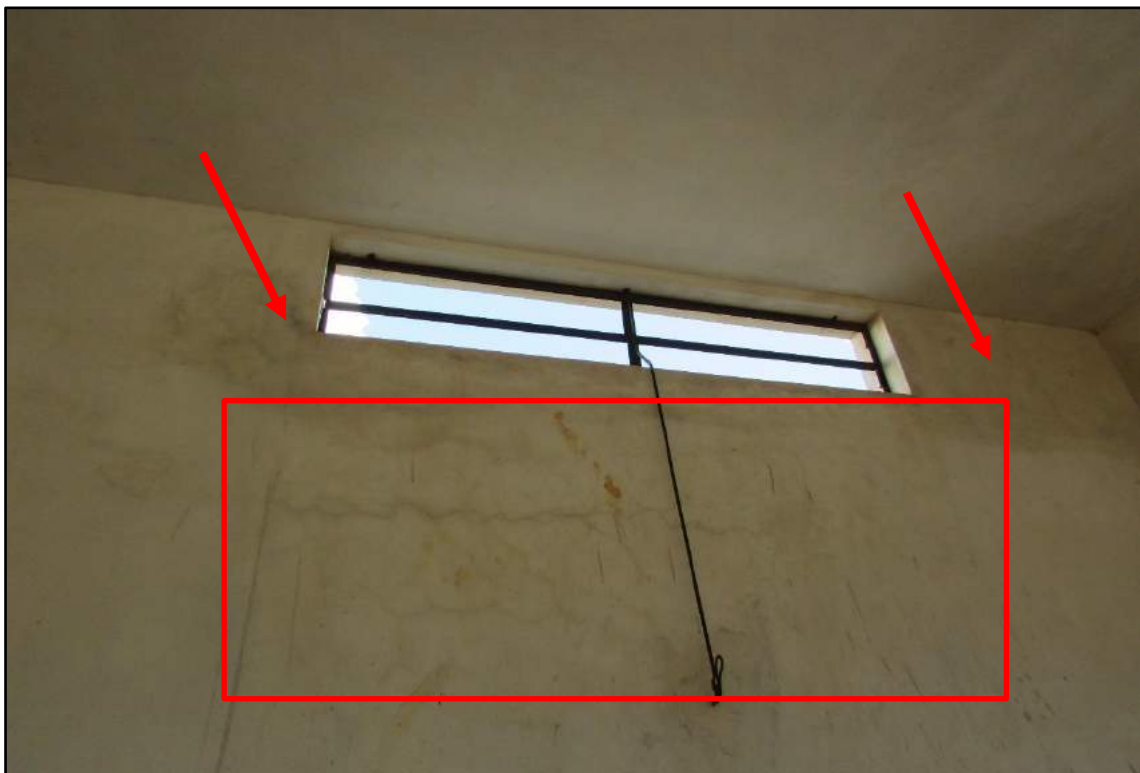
Infiltração no teto e parede. Presença de fissuras geométricas no revestimento da parede.
